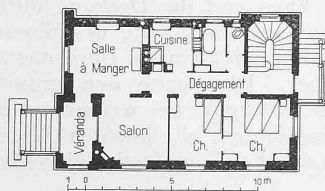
Plan du rez-de-chaussée de la maison Ballissat. — 1 : 400.
